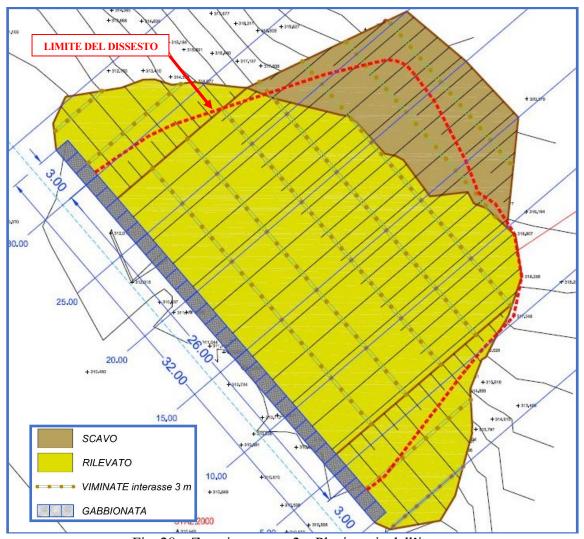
Zona intervento 2 – Planimetria dell'intervento
